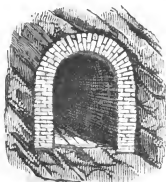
Muraillement d'une galerie dont le sol est consistant.
